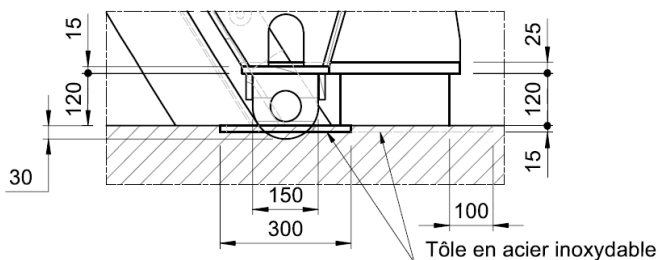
Détail du joint d'étanchéité du bord inférieur de la porte amont (coupe verticale)
